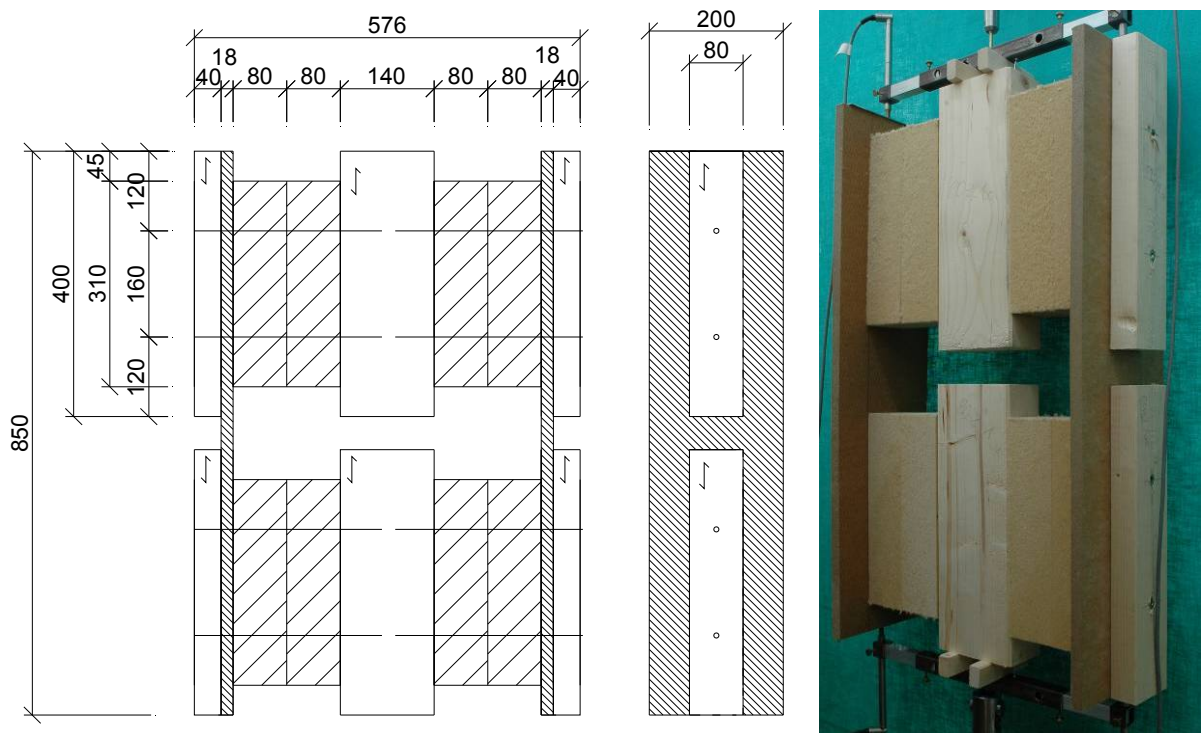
Zugscherkörper einer Holz-HFDP-Verbindung in einem zweilagigen Aufsparrendämmsystem (Dämmschicht 2 x 80 mm, Maße in mm)
